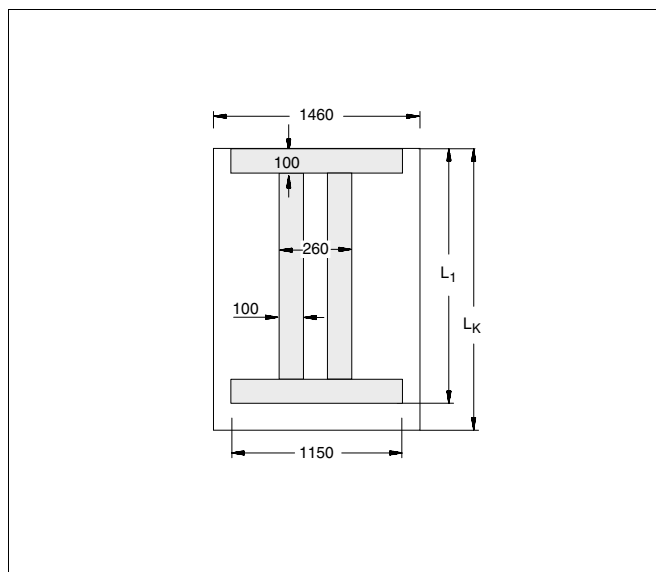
Dimensiunile postamentului (dimensiuni în mm)
